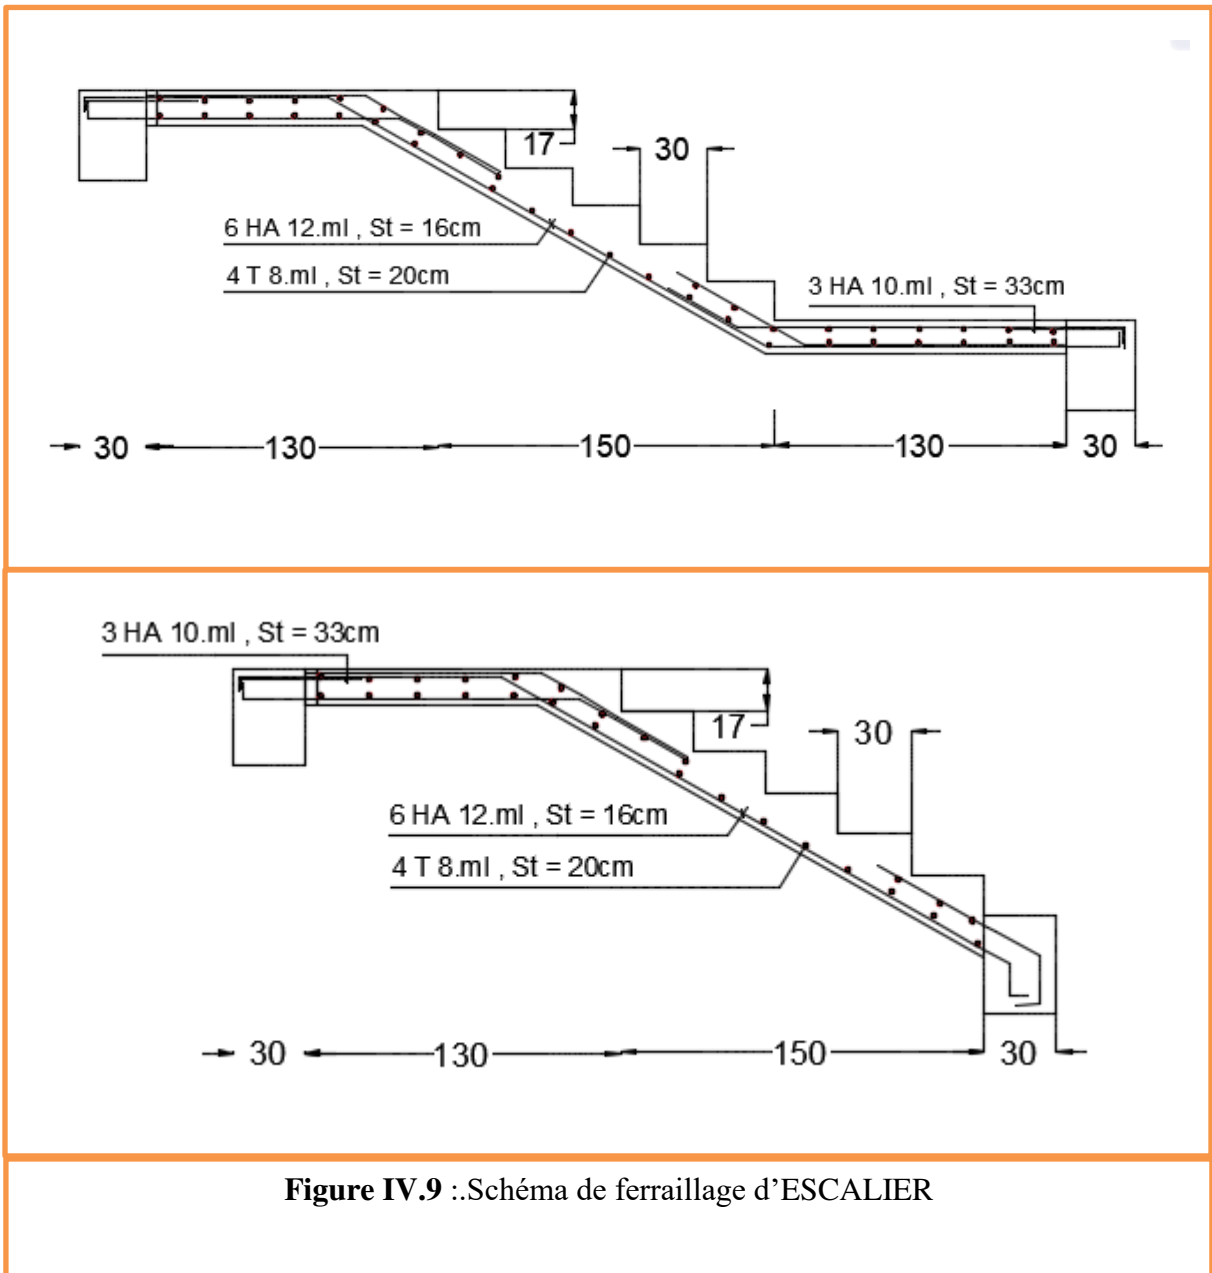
Schéma de ferrailage d'ESCALIER
